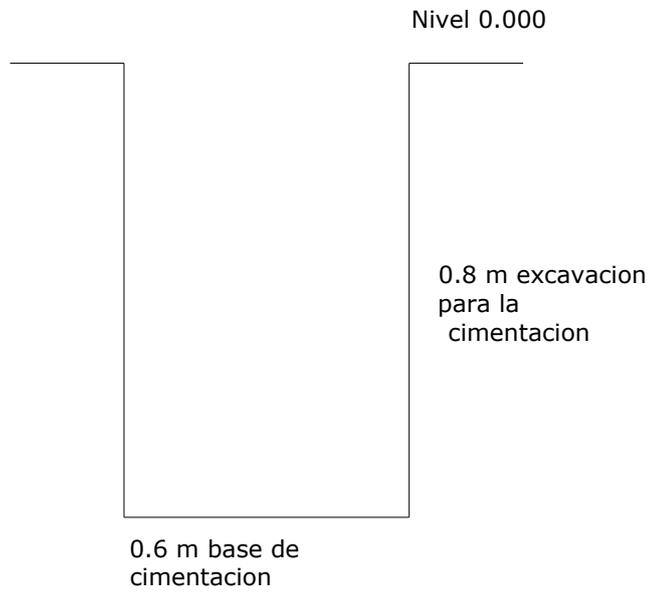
Excavación para obras de cimentación e instalación de obras sanitarias, cámaras de inspección
